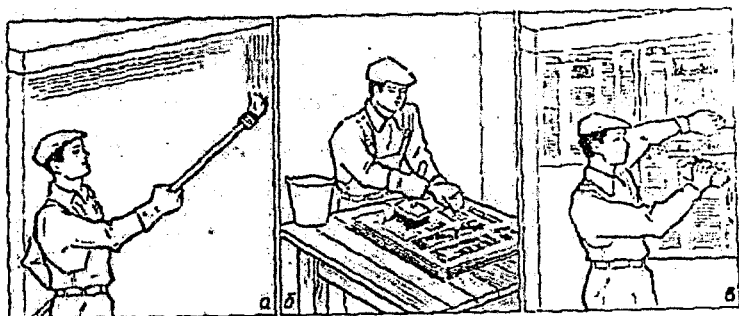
Підготовка поверхонь для наклеювання шпалер:
